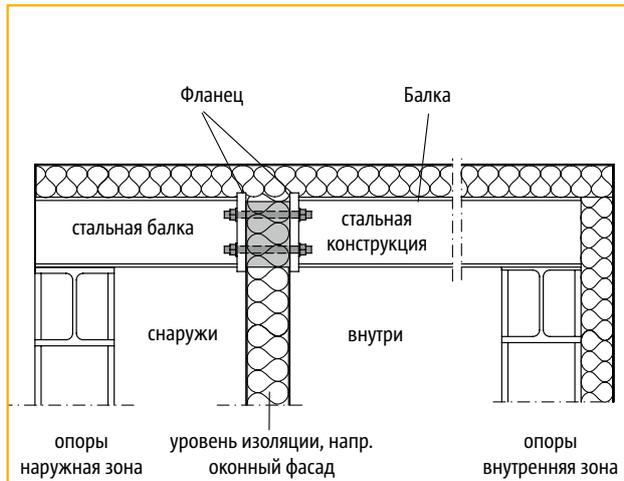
Schöck Isokorb® модуль KST-QST для разделения внутри конструкции
